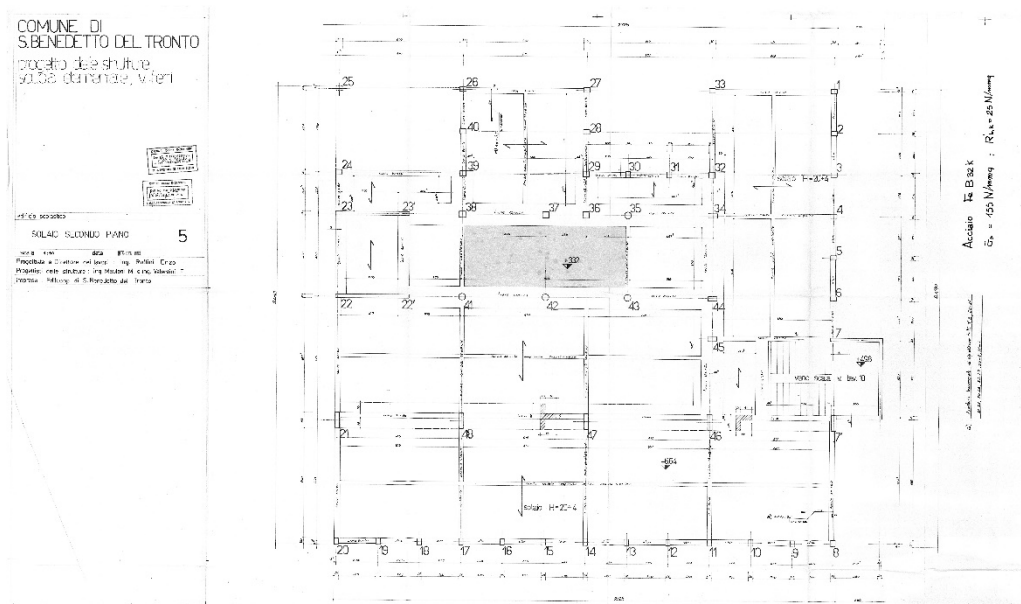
Tavola progetto originario- Carpenteria piano secondo
